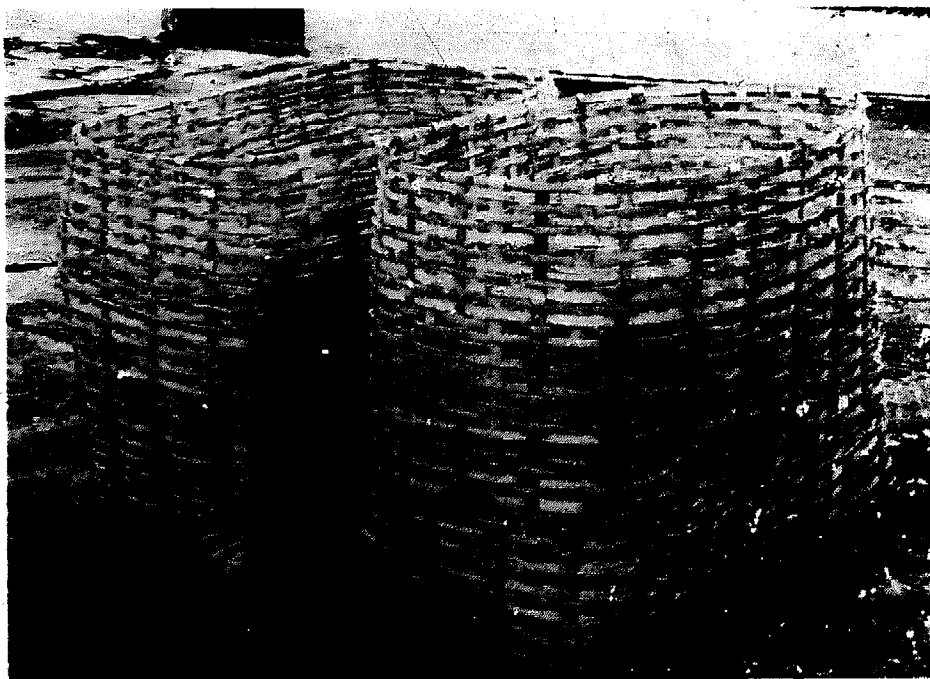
Canastas utilizadas en la construcción de los tanques.
